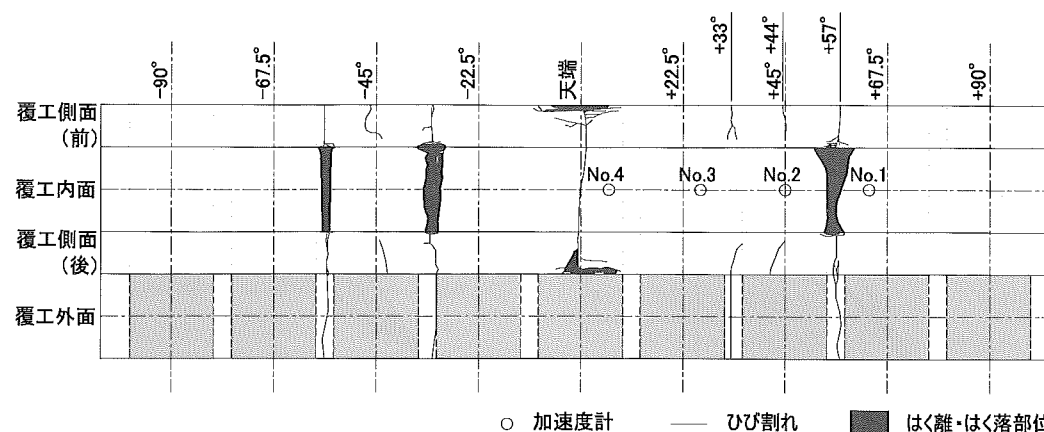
天端変位が50mmのときのひび割れなどの状況
